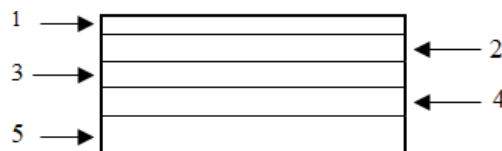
Schéma en coupe d'un plancher terrasse inaccessible.
